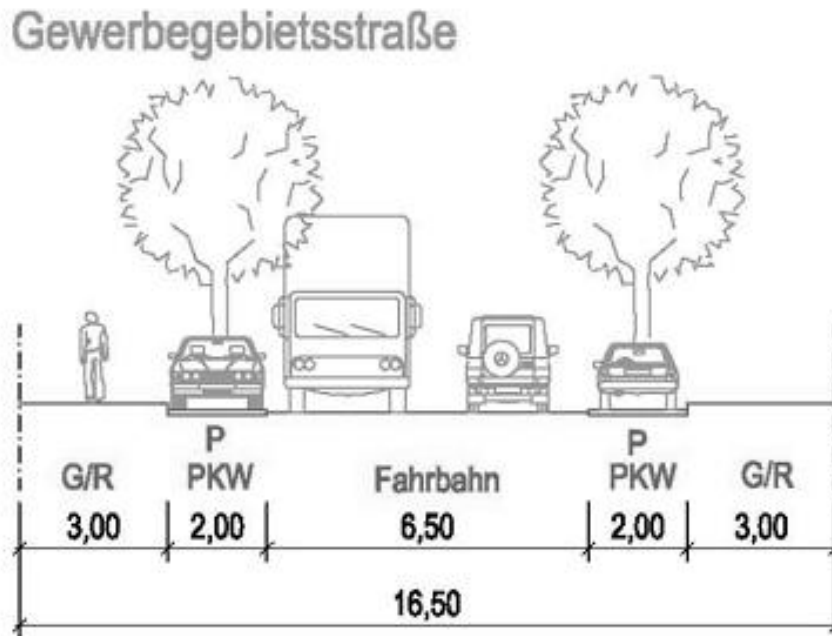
Querschnitt für Gewerbestraßen nach RASSt 06, Bild 35 / 9.2
